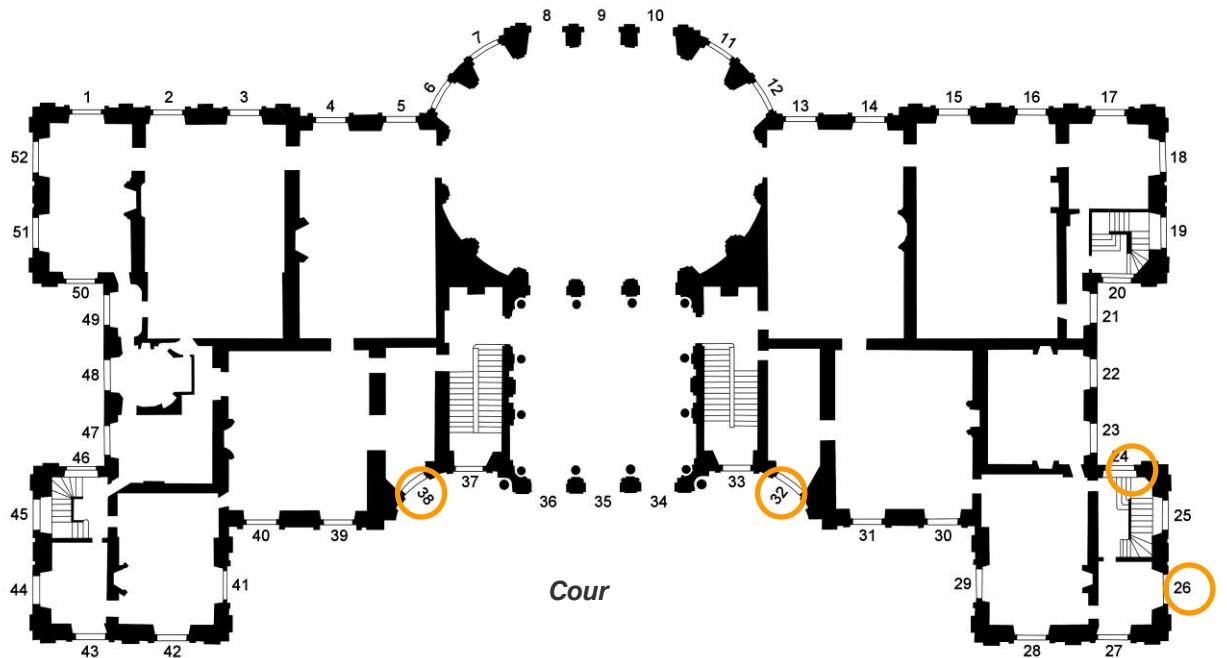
Plan d'implantation des prélèvements sur les croisées anciennes au niveau du rez-de-chaussée (Source : relevé de Rodolphe Pfnor, 1888)
